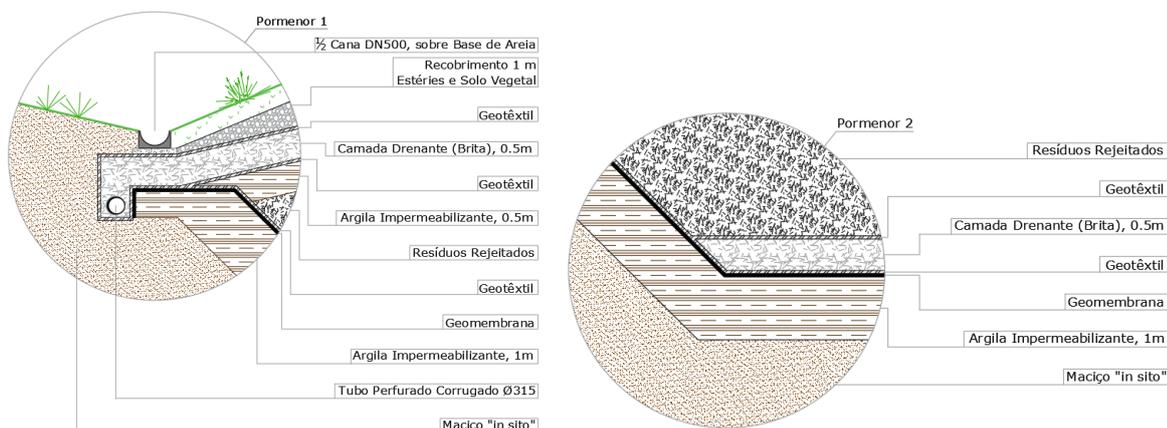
Pormenor do sistema de impermeabilização previsto no projeto de execução das instalações de resíduos para rejeitados.
